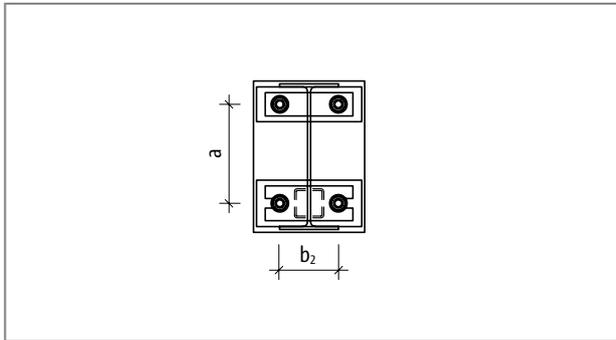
Bündige bauseitige Stirnplatte T Typ S: geometrische Eingangswerte Berechnung; Ansicht
